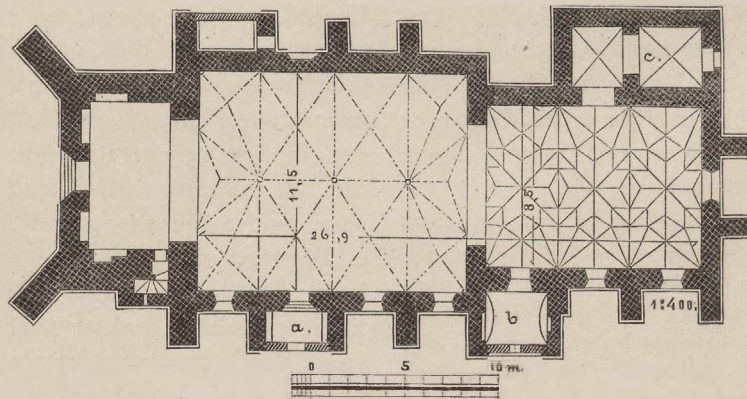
Adl. Liebenau. Grundriss der Kirche.
